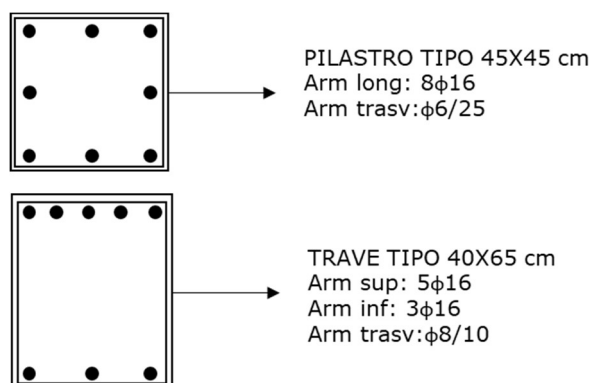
Dettagli costruttivi delle sezioni di travi e pilastrì relativi al primo impalcato.
